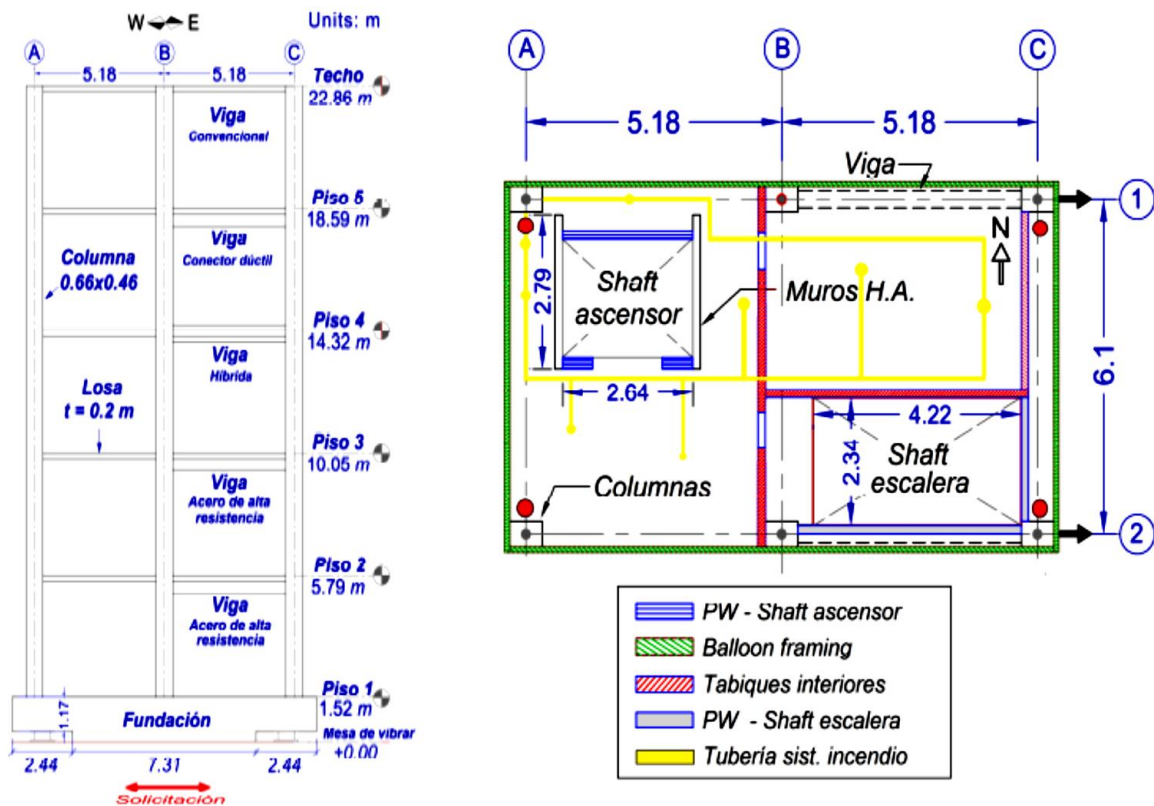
Elevación del marco y planta del piso 1 de la estructura ensaya
